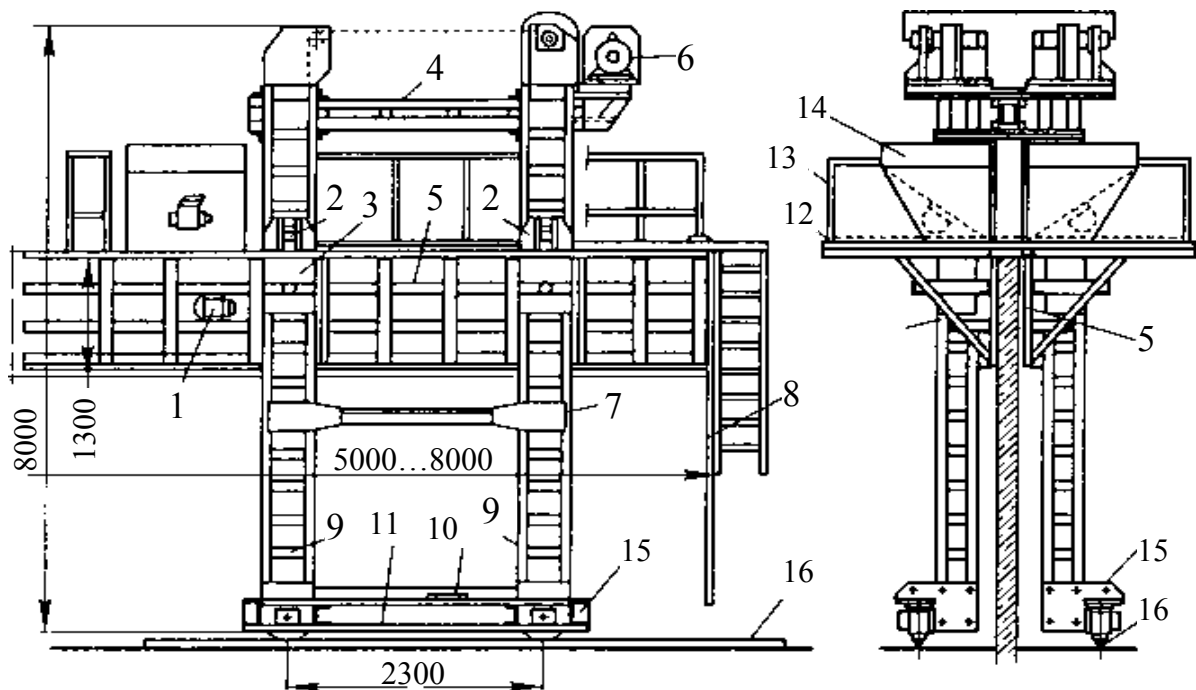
Котюча опалубка для бетонування стін: 1 – вібратор; 2 – фіксатори; 3 – повзуни; 4 – з'єднувальна балка; 5 – щит опалубки; 6 – лебідка для піднімання щитів; 7 – монтажний пристрій; 8 – сходи; 9 – стійка котючої опалубки; 10 – електричний привід; 11 – візок; 12 – робочий настил; 13 – огорожа настилу; 14 – бункер для бетонної суміші з вібратором; 15 – візок для горизонтального переміщення; 16 – рейковий шлях порталу для переставляння на наступний ярус бетонування
